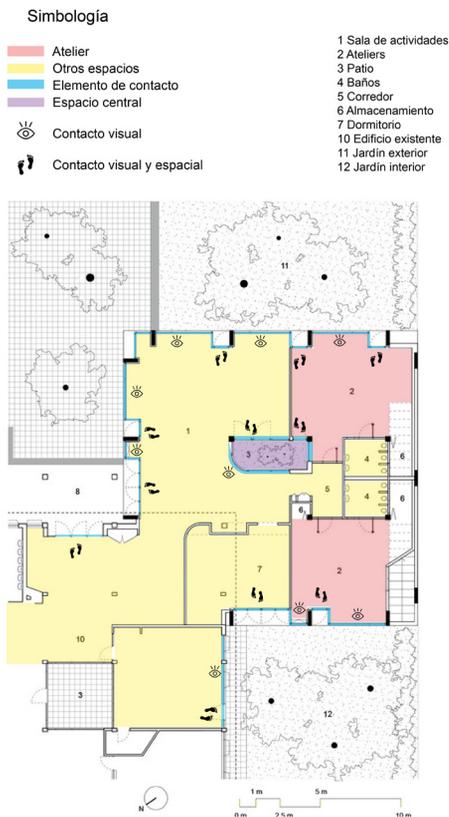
Planta arquitectónica; escuela El Jardín Cubierto
